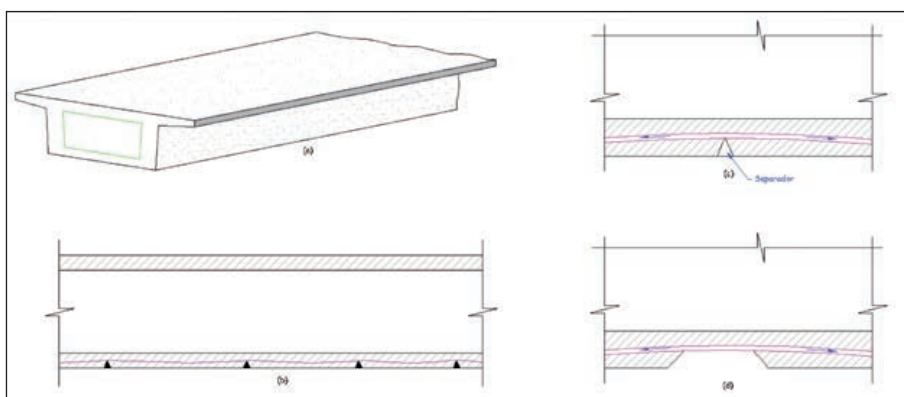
FISURAS POR EMPUJE AL VACÍO DEBIDAS A DESVIACIONES EN EL TRAZADO REAL DE TENDONES (FIG.b), BIEN POR SEPARACIÓN EXCESIVA DE LOS SEPARADORES O CALZOS, BIEN POR EL DESCENSO DEL TENDÓN ENTRE ELLOS DEBIDO A PISADAS DEL PERSONAL, ETC. LA FIGURA c) INDICA LA RESULTANTE DE FUERZAS Y LA d) LA ZONA FISURADA O EXPULSADA.
